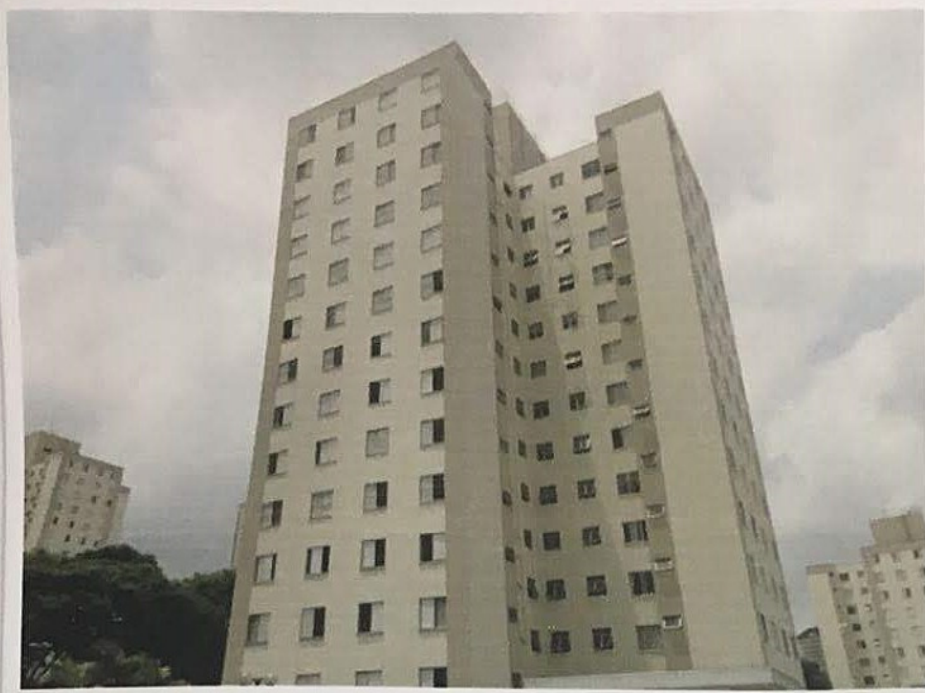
Vista mais ampla da fachada do bloco nº 10.
